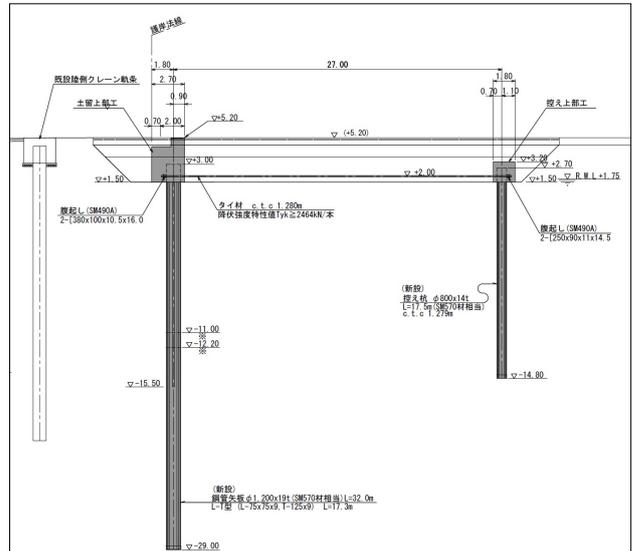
鋼管矢板打設による飛島ふ頭改良の断面図
